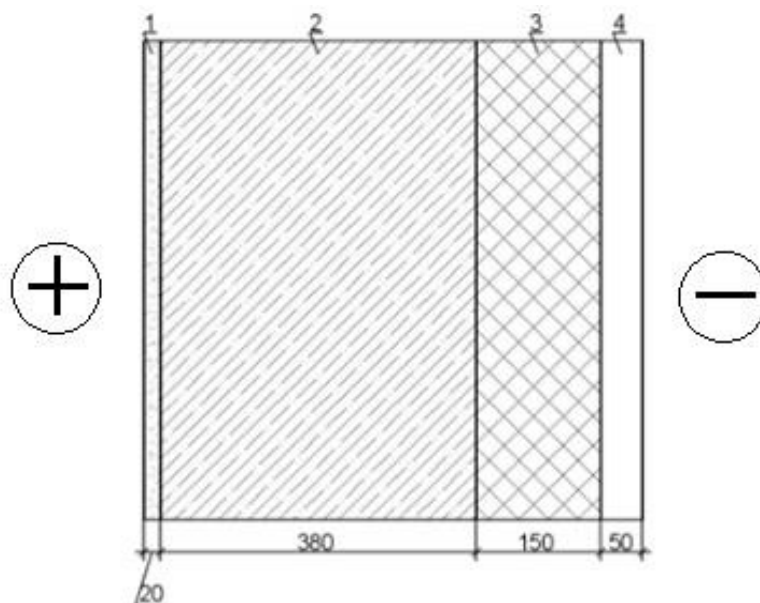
Схема ограждающей конструкции наружной стены
